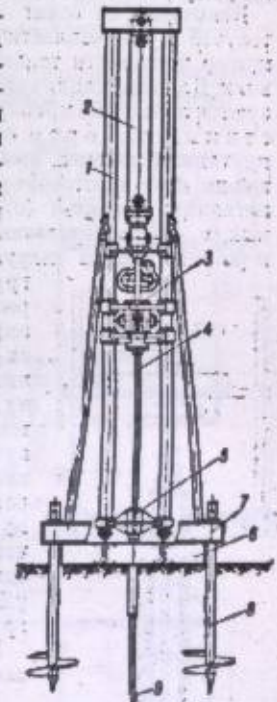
Установка для статического зондирования грунтов: 1 — направляющая; 2 — гидравлич. домкрат; 3 — измерит. головка с двумя динамометрами; 4 — штанга; 5 — труба; 6 — рама; 7 — балки с упорными болтами для крепления рамы; 8 — винтовая свая; 9 — зондирующий конус.
